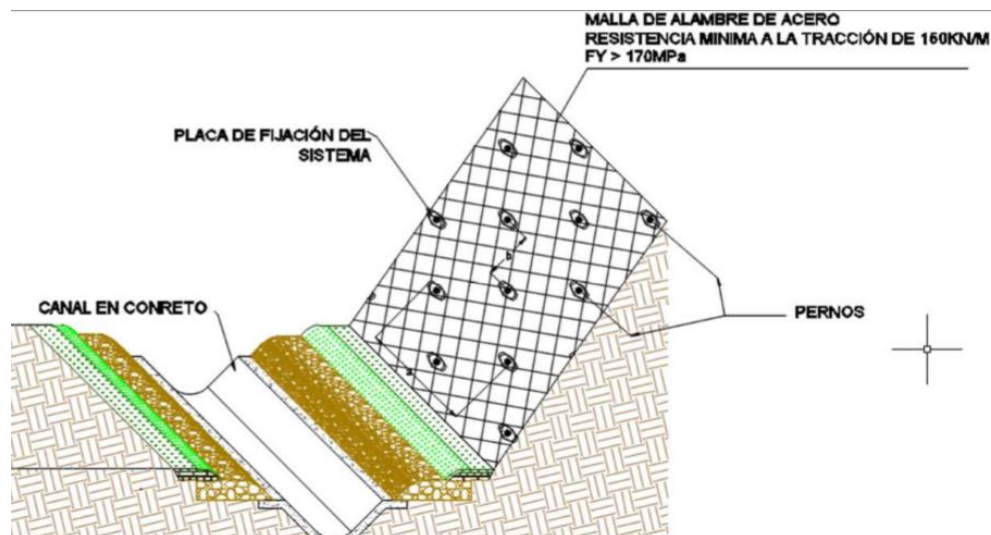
Detalle del sistema de malla de alta densidad con Nails.
